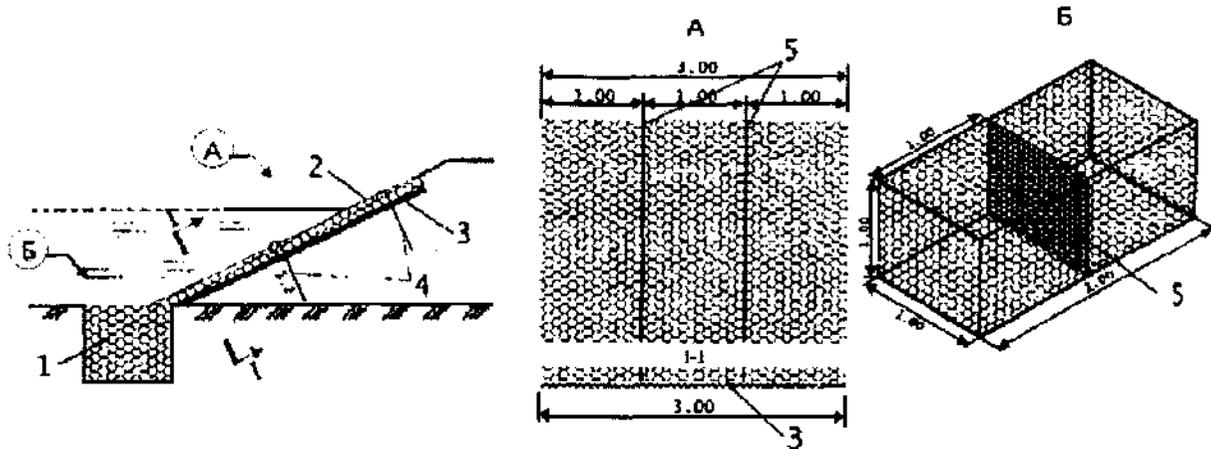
Конструктивная схема габионных конструкций коробчатой формы
